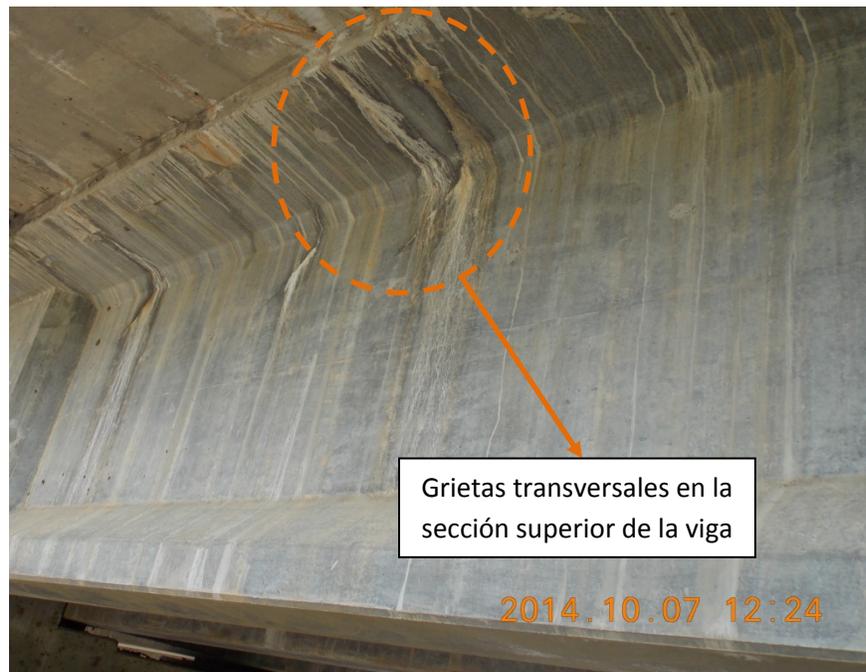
Eflorescencia y agrietamiento vertical en vigas.
